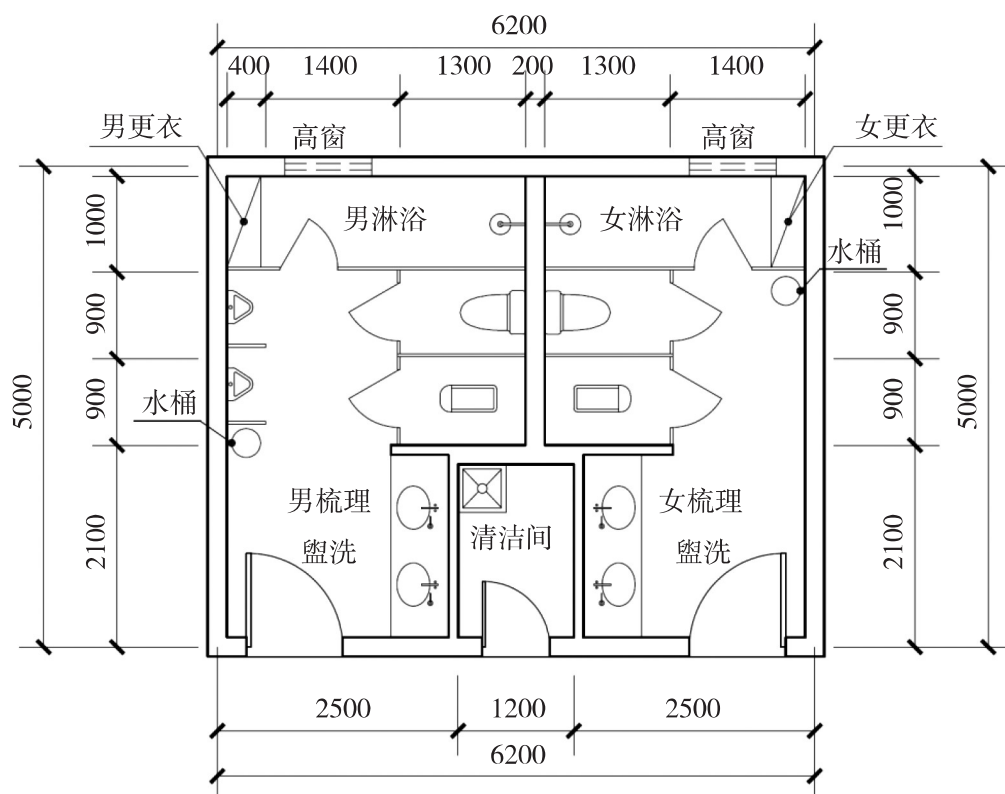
三类小澡堂平面布局示意图 (mm)
